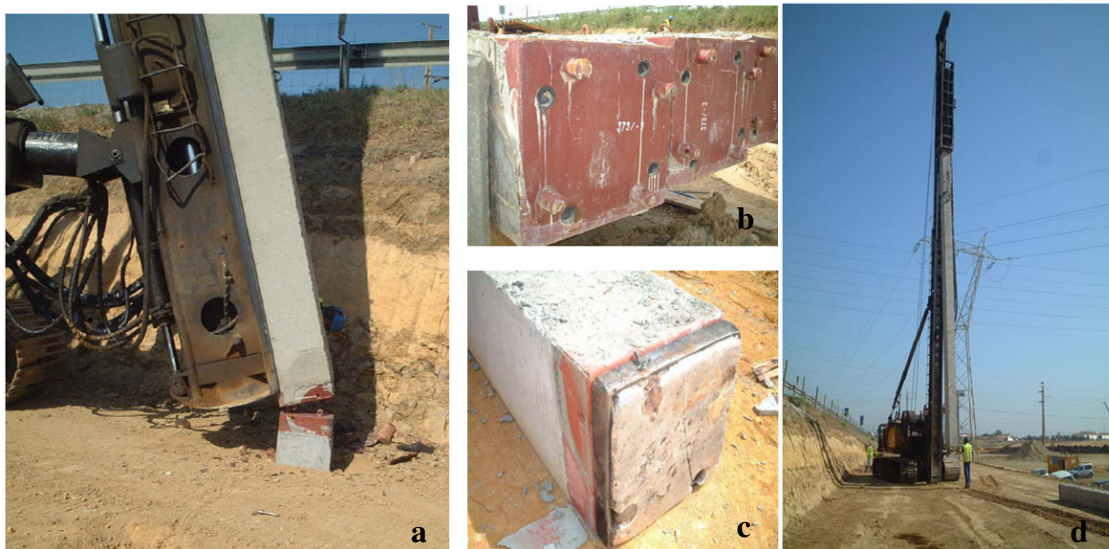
Estacas cravadas e instaladas por troços: a) sistema de ligação entre troços; b) junta de ligação entre estacas; d) cabeça de estaca pré-fabricada em betão armado; e) cravação de estaca (Miranda e Martins, 2006).
